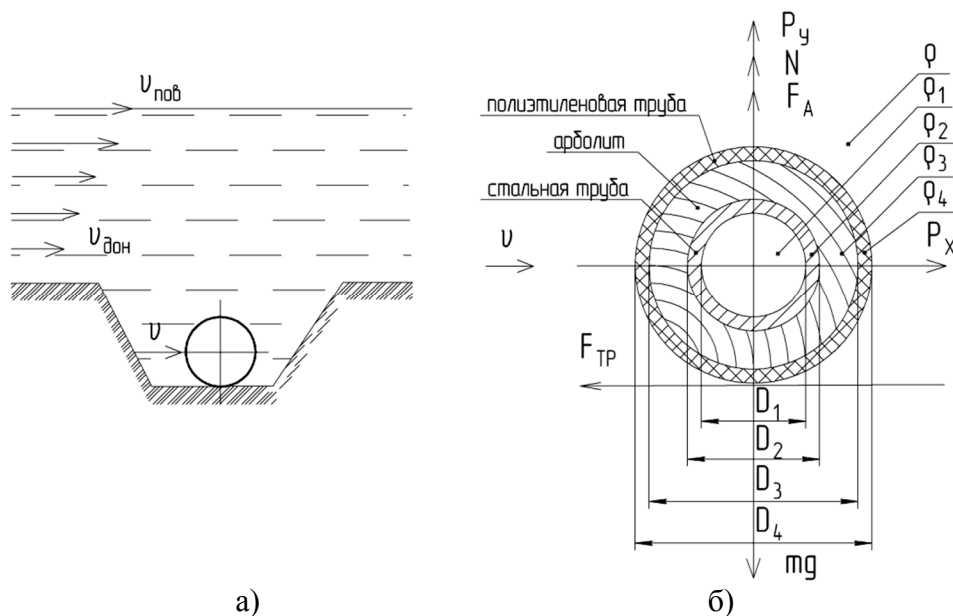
Расчётная схема нагрузок и воздействий на подводный трубопровод в траншее: а – общая схема размещения трубопровода на дне водоёма; б – схема сил, действующих на трубопровод
